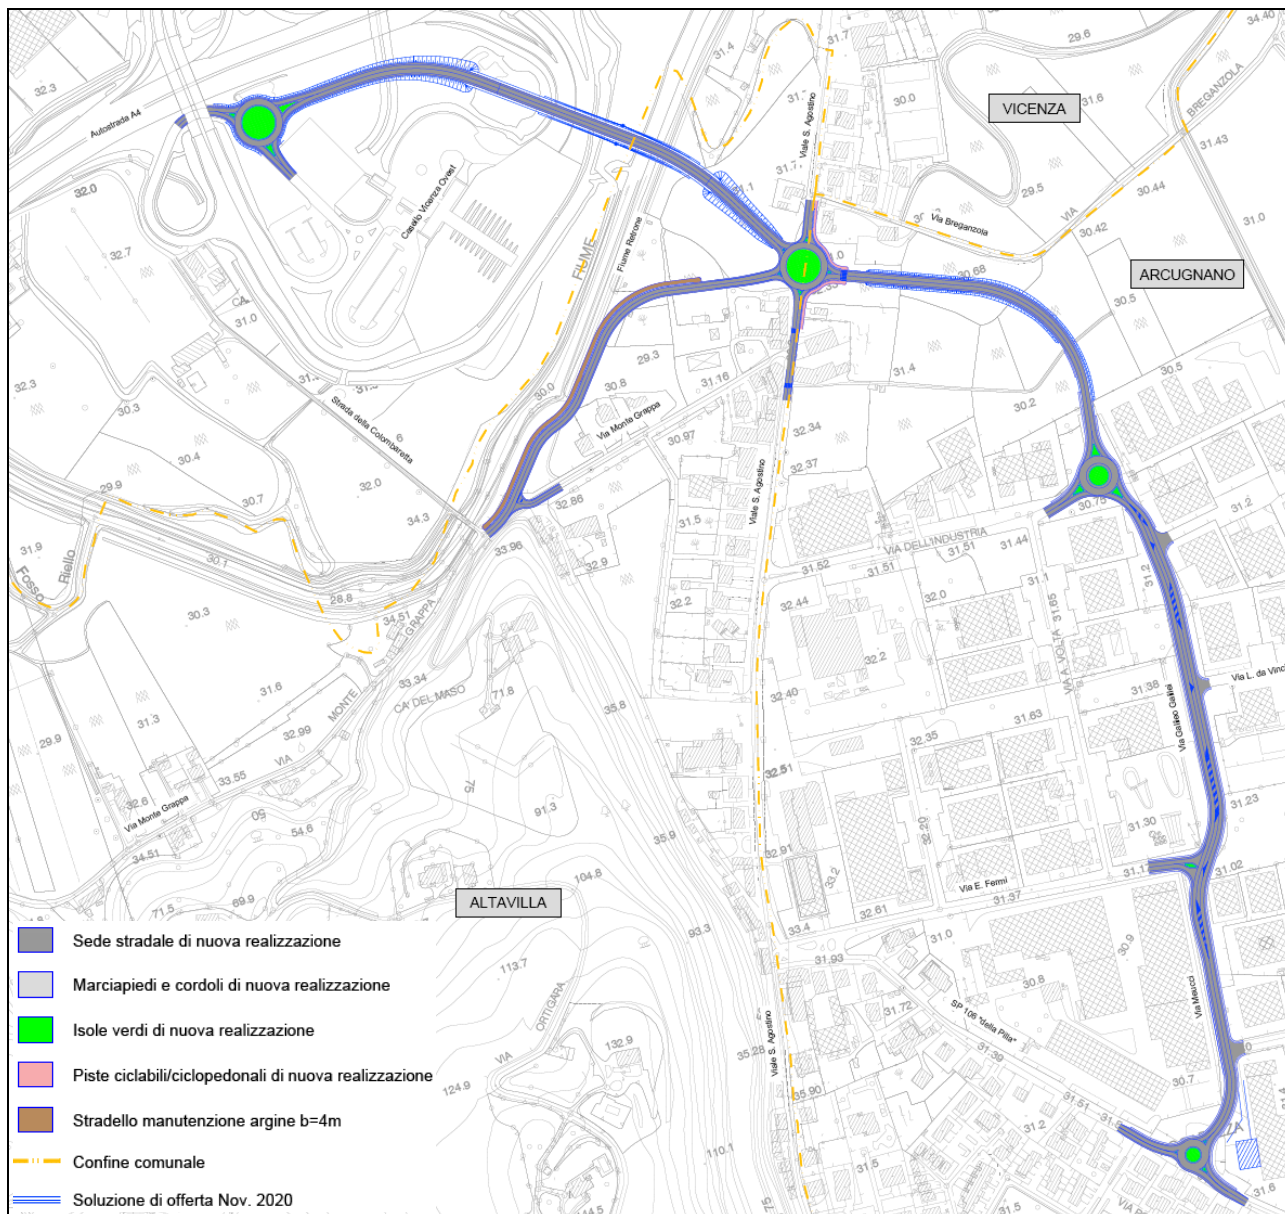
Planimetria della soluzione progettuale offerta in fase di gara (novembre 2020)
